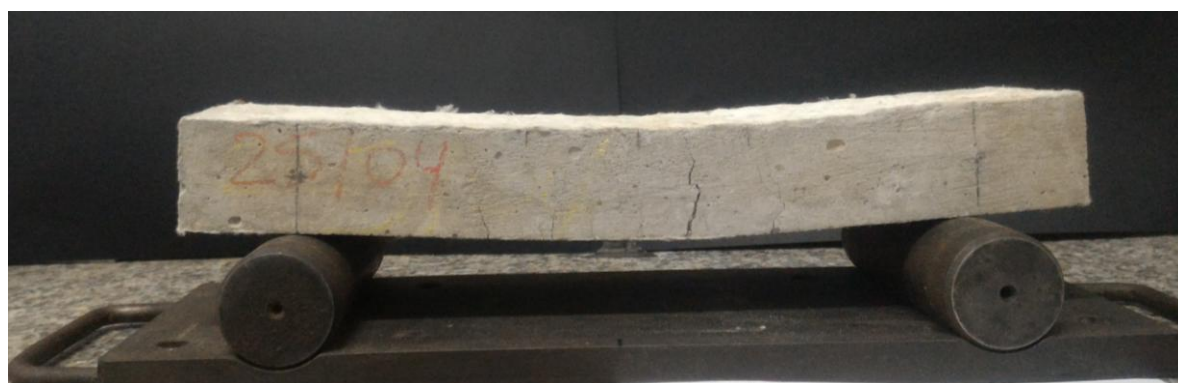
Vista lateral da Viga ECC_{Ref} 401 após terminado o ensaio de fadiga. Fonte: foto do autor.
